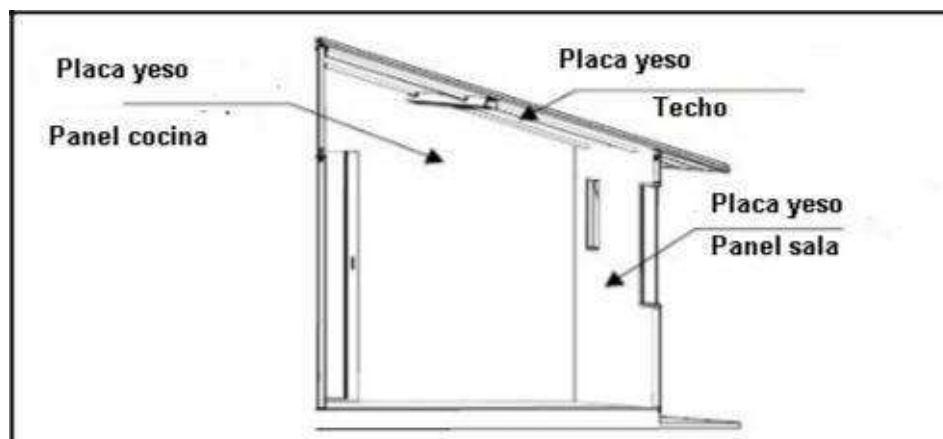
Detalle de la fijación del revestimiento doble de Drywall
